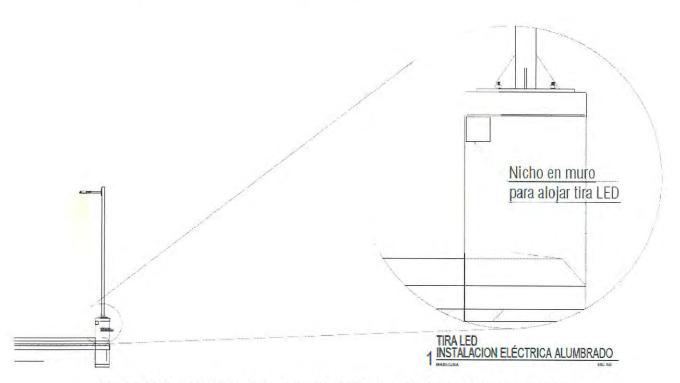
Detalle de nicho para tira LED en cajón lateral (viga longitudinal).
